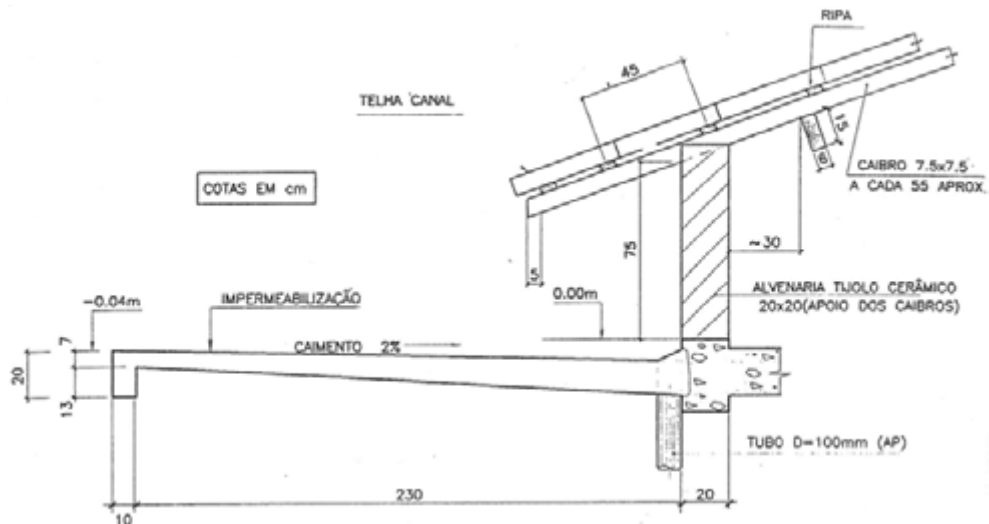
8 - Detalhe de reconstrução de marquise do Hospital Barata Ribeiro – CUNHA et. al. (1996)
